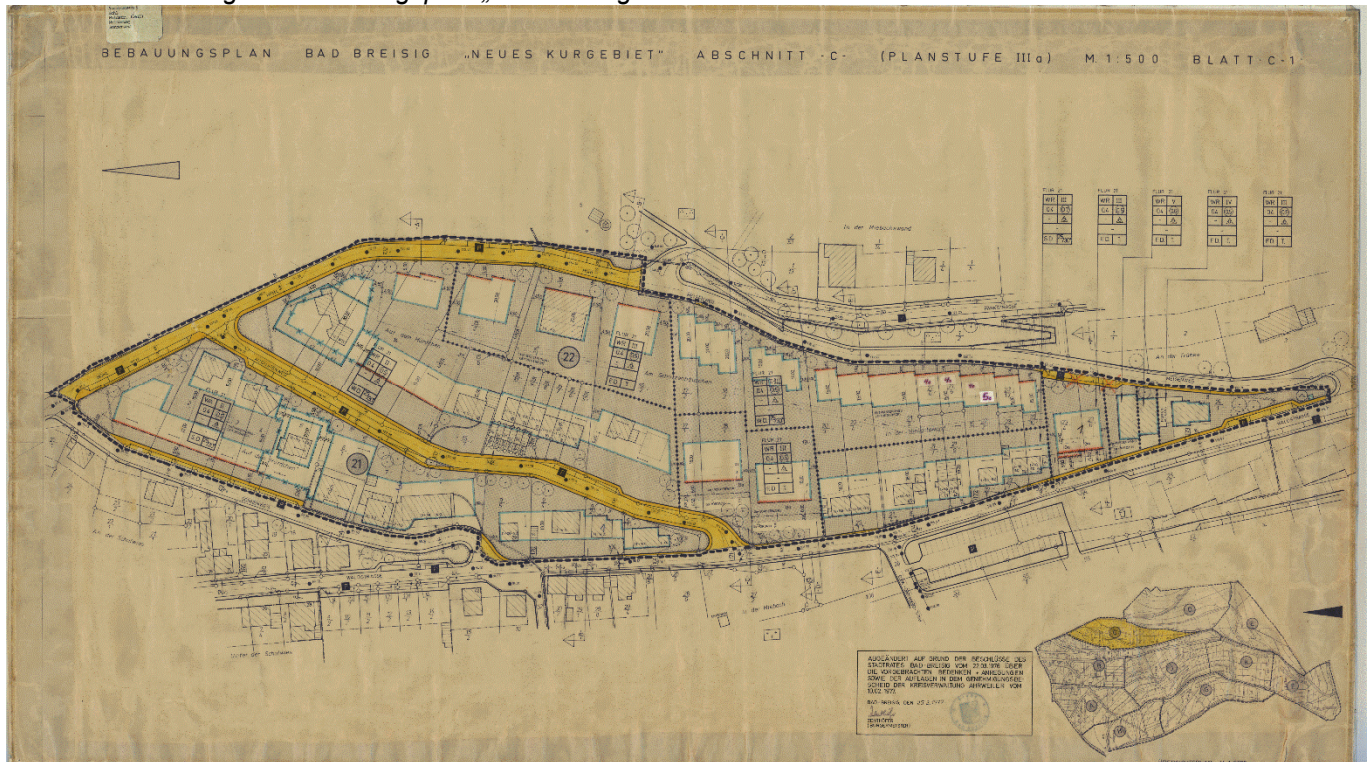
Bebauungsplan „Neues Kurgebiet Planstufe II“
